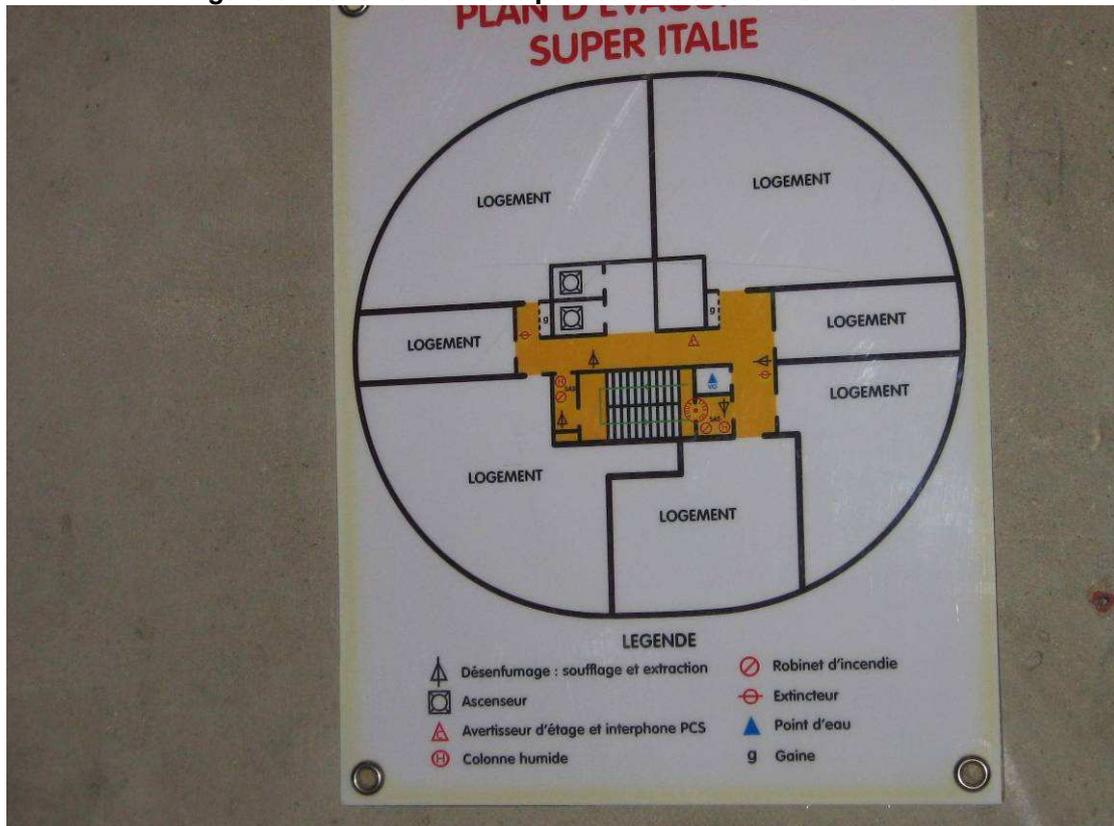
plan d'étage d'un immeuble complexe - 1 seul palier - 2 gaines techniques
